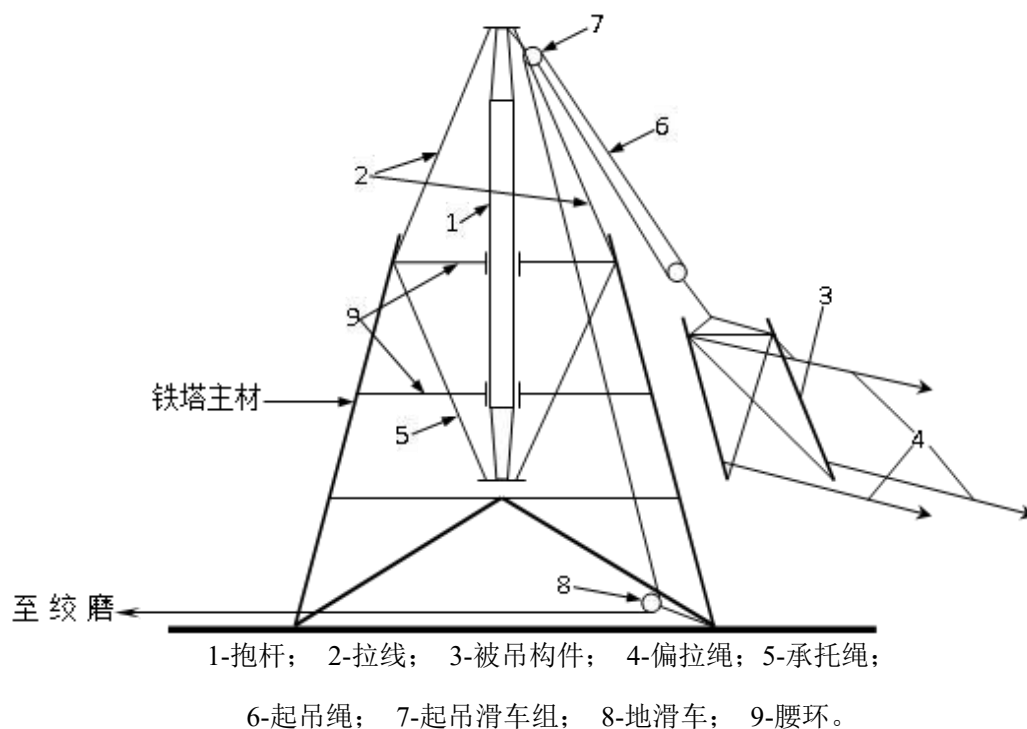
内拉线抱杆组塔现场布置示意图
